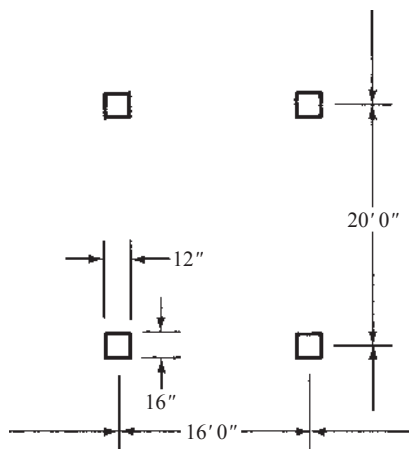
Tablero interior de la estructura de placa plana del ejemplo 16.1.
